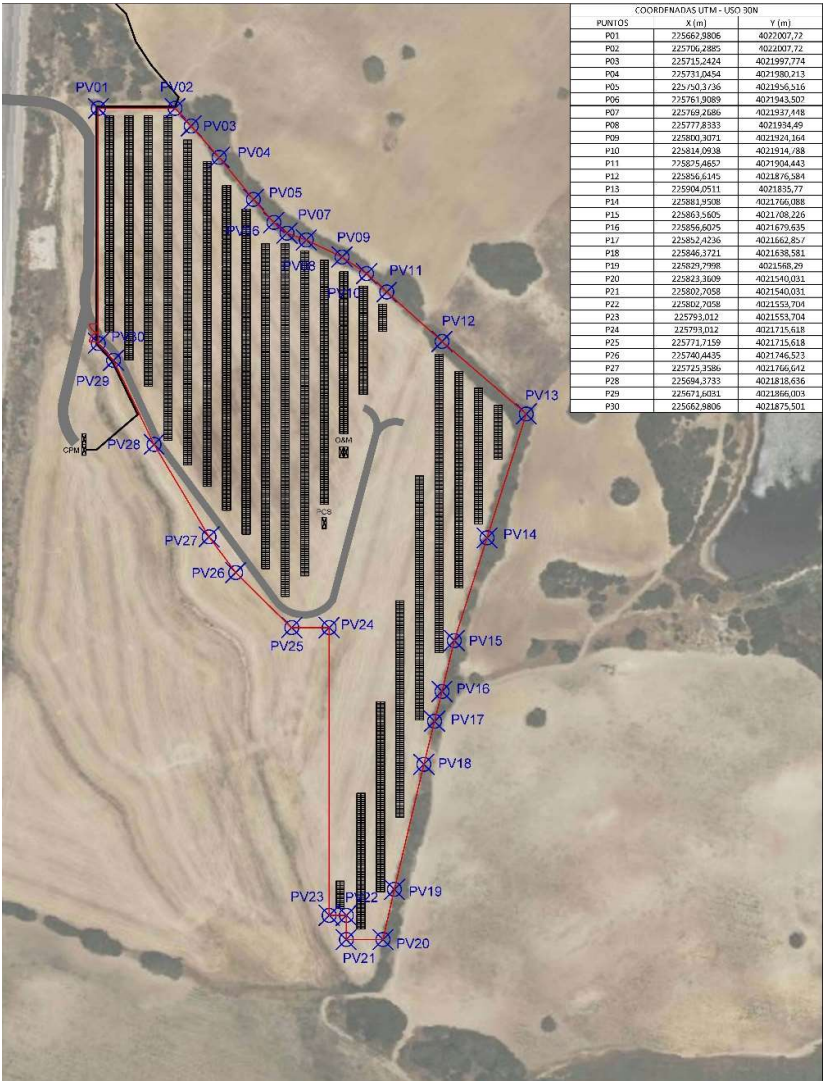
Coordenadas puntos vallado planta fotovoltaica
